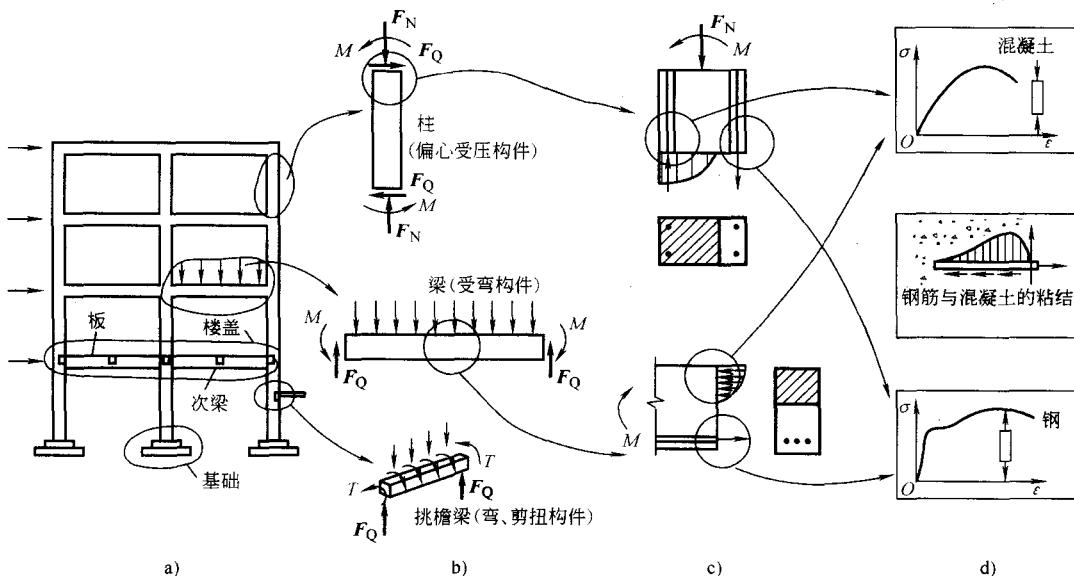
钢筋混凝土框架结构及其构件的受力状态
